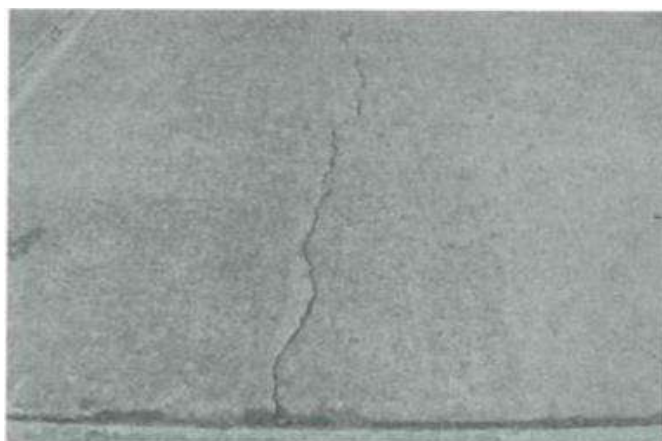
Trinca por Recalque da Fundação (Fonte: Silva, 2008)
